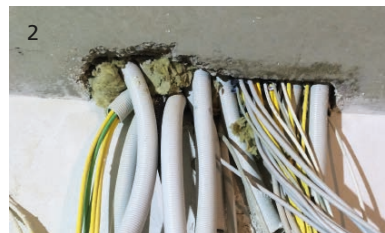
• Die Durchführungsöffnung ist zu klein bemessen.
